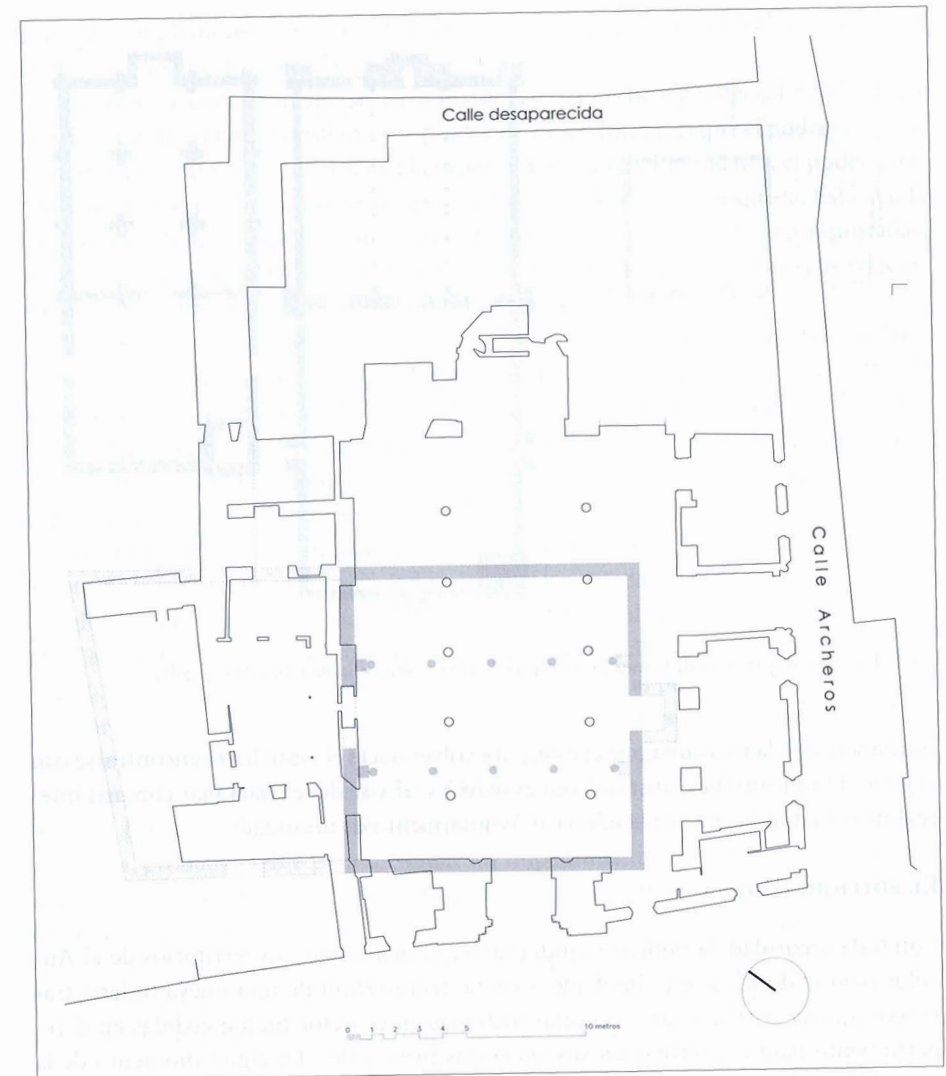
Planta de la mezquita superpuesta a la planta de la actual iglesia.
